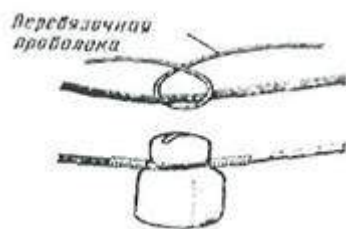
Крепление провода к изолятору на угловой опоре.
